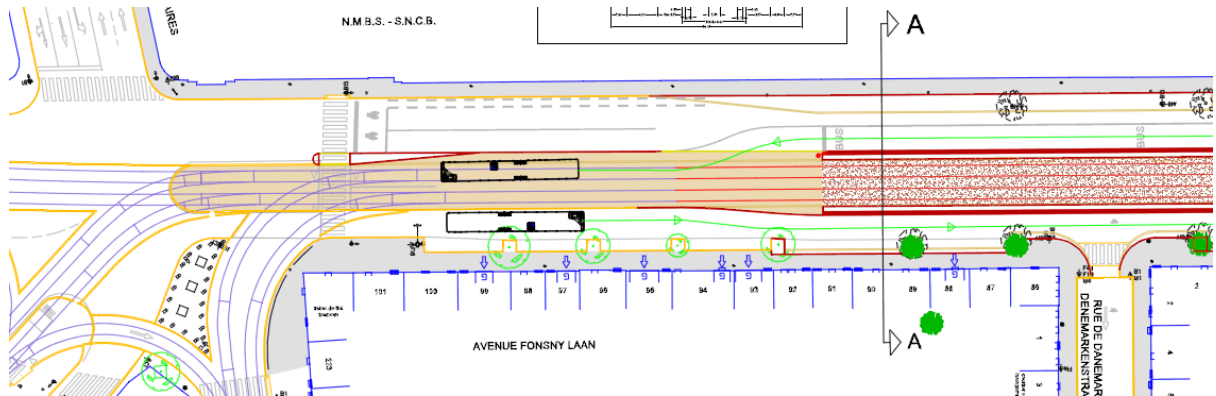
Vue en plan – implantation Sud de la trémie projetée
